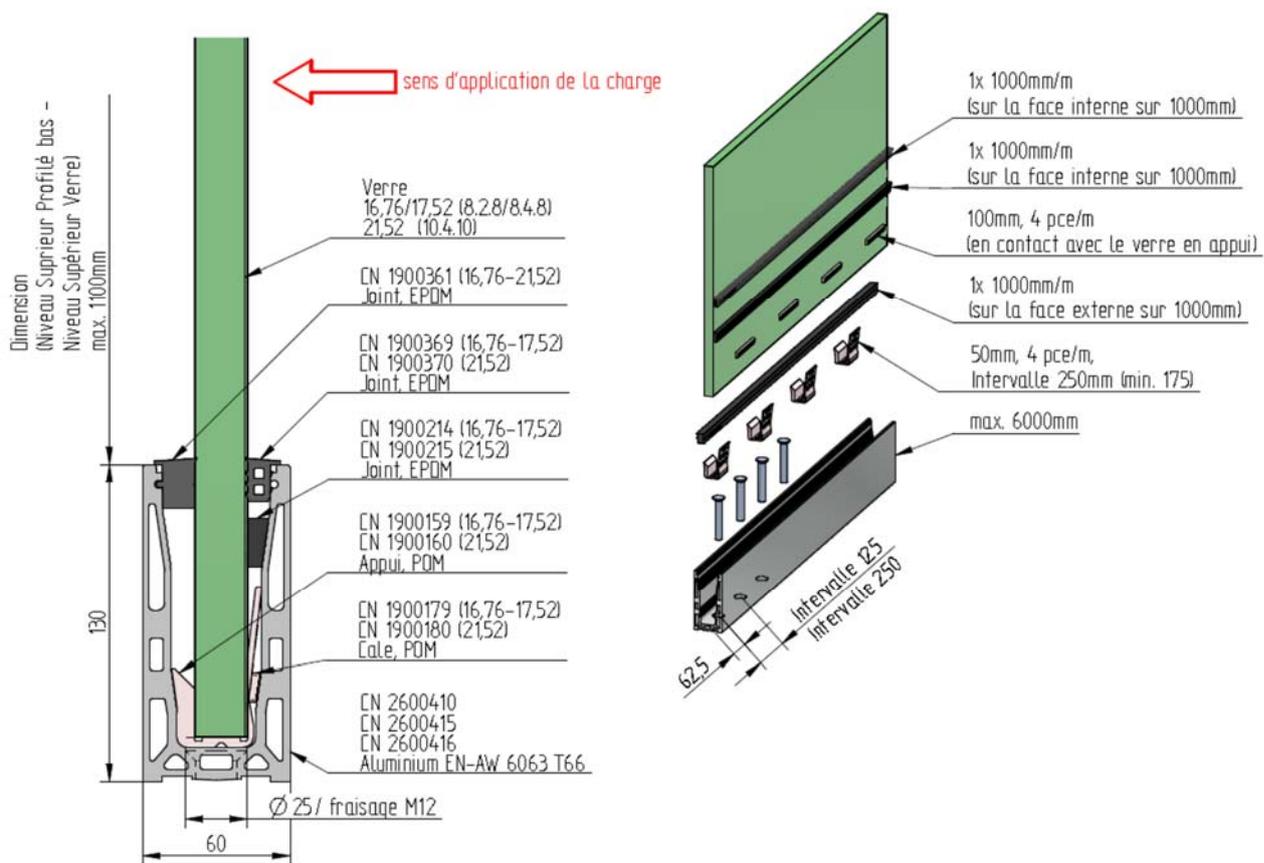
CROSILUX 2.0 LIGHT – Montage sur dalle
